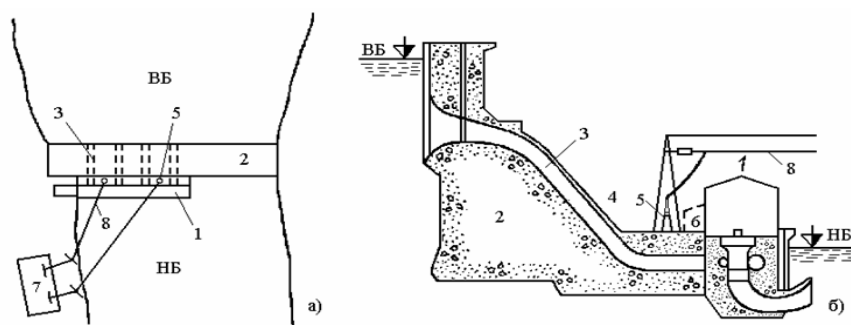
План (а) і поперечний переріз (б) ГЕС, розташованої біля греблі
